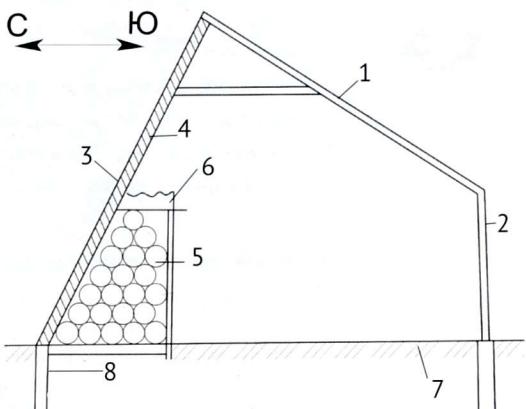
1 – прозрачная изоляция, 2 – опорная стена, 3 – северная стена, 4 – теплоизоляция, 5 – галечный аккумулятор, 6 – ящики с рассадой, 7 – защищенный грунт, 8 – теплоизолированный фундамент.
